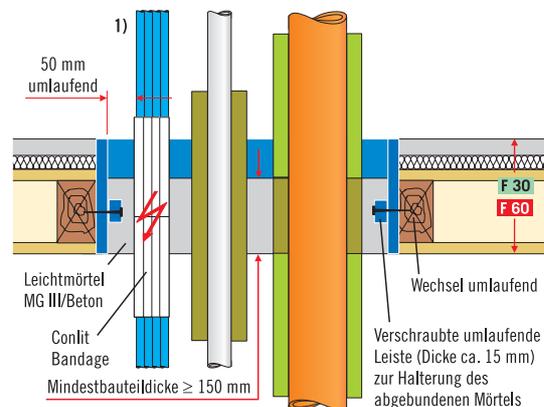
Beispiel zur Abschottung in einer F 30- bis F 60-Holzbalkendecke (gilt für die Gesamtkonstruktion) mit Verschluss aus Leichtmörtel MG III/Beton
